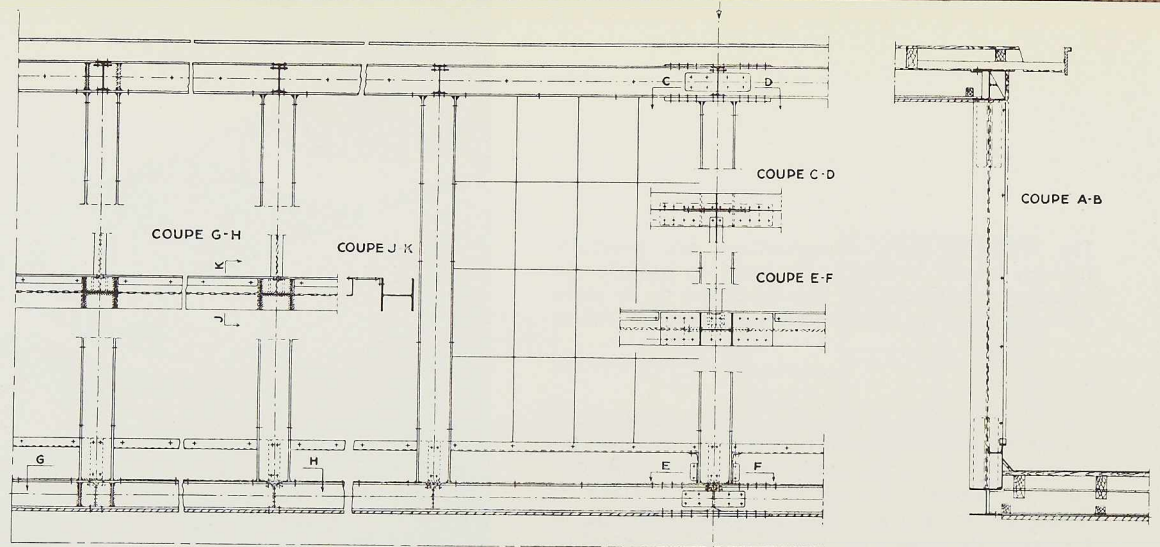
Vue en élévation et en coupe d'une poutre Vierendeel construite en soudure.
